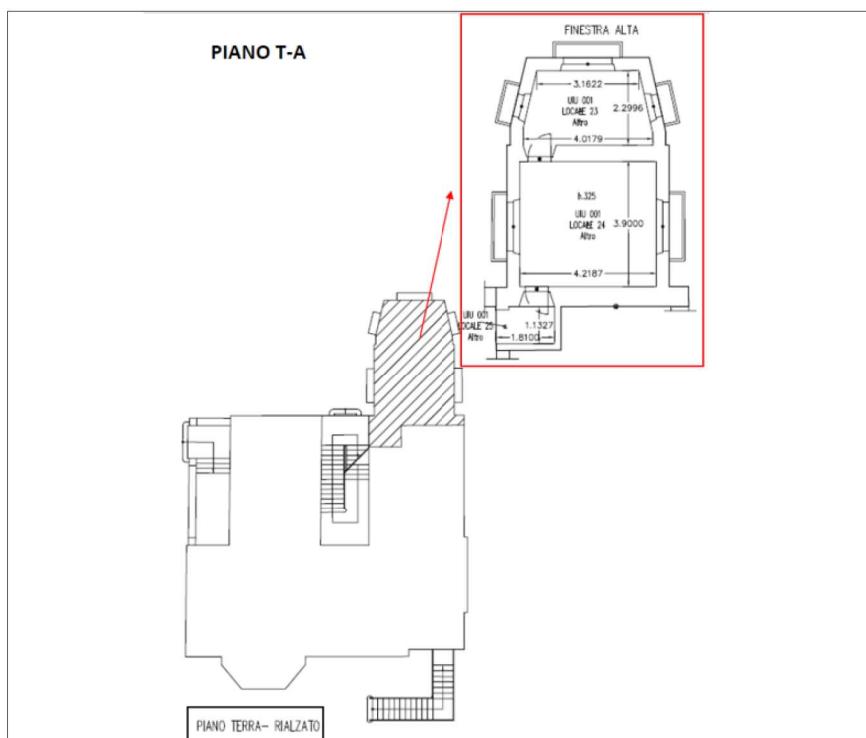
Planimetria Piano Terra Ammezzato - Palazzina Liberty di Villa Gruber
